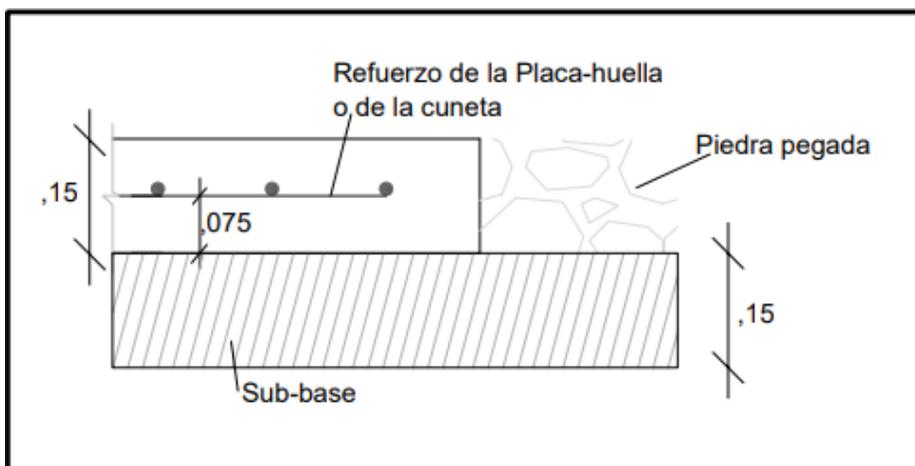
Junta longitudinal entre Placa-huella o Berma-cuneta y la Piedra pegada
